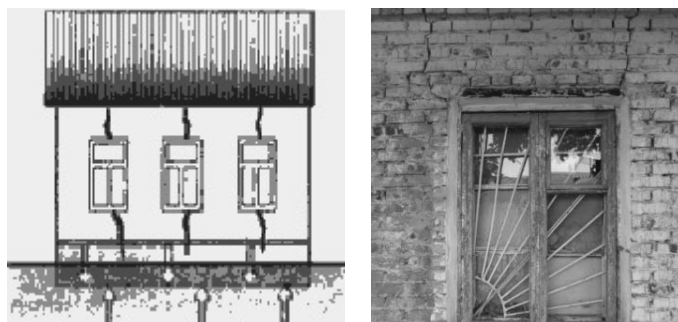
Разрыв кладки и образование трещин при недостаточной глубине заложения фундамента
